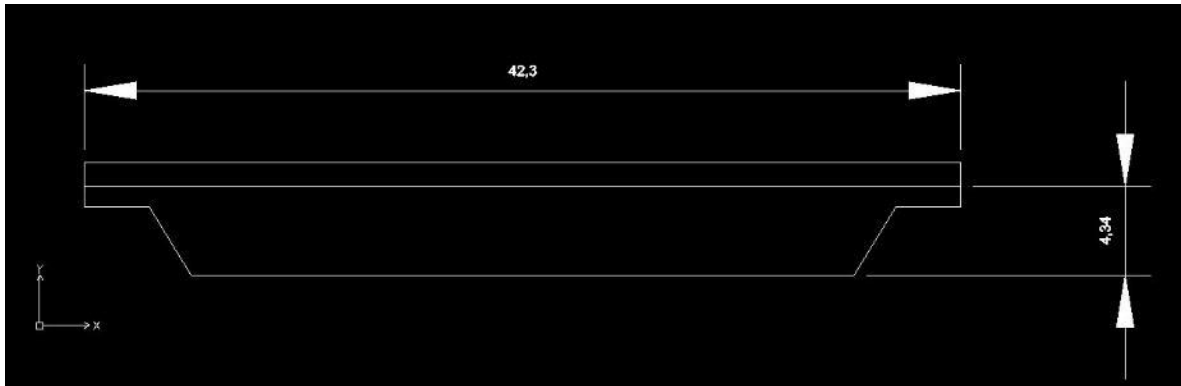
Perfil del puente en la parte baja del modelo de Cuipilapa
